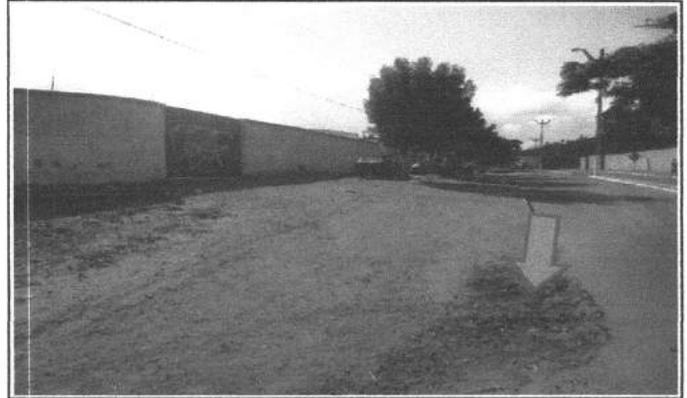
EXECUÇÃO DE CAIXA EM ALVENARIA
